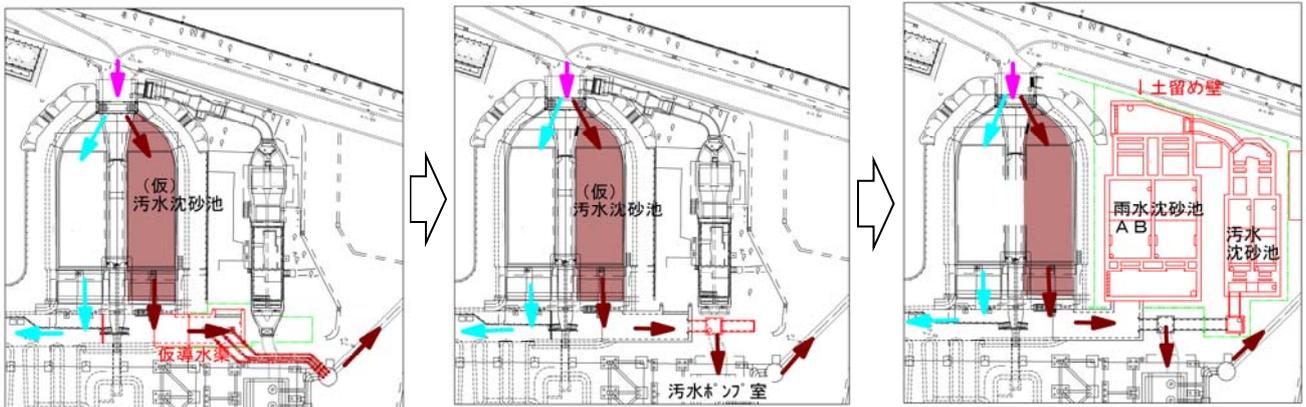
施工ステップ1 (汚水沈砂池及び雨水沈砂池A B築造)
